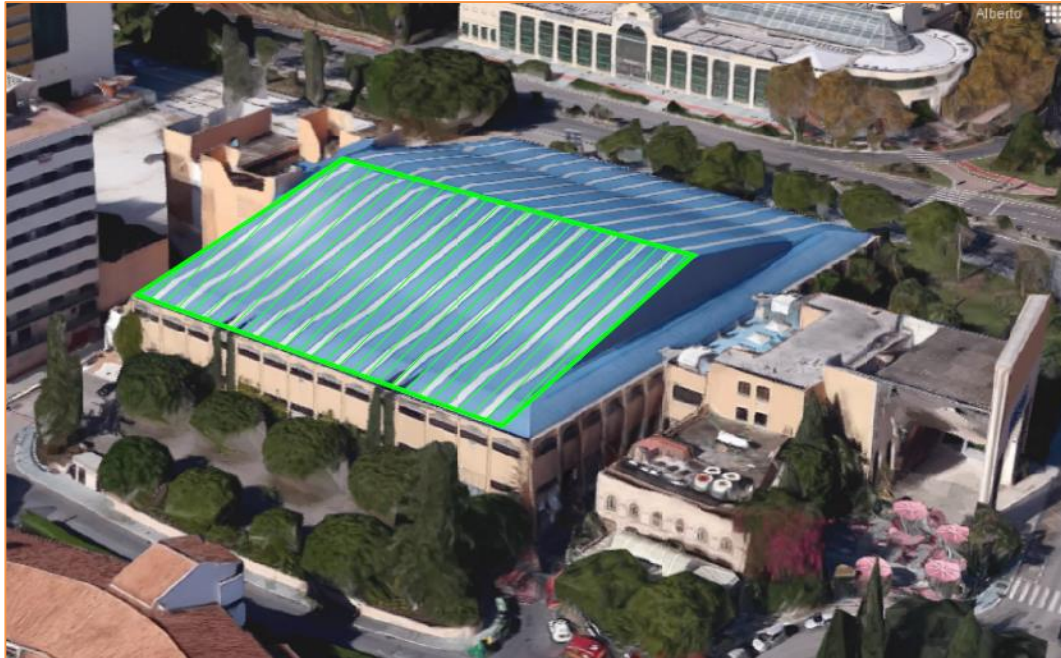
Cubiertas consideradas para la implantación de los módulos fotovoltaicos
